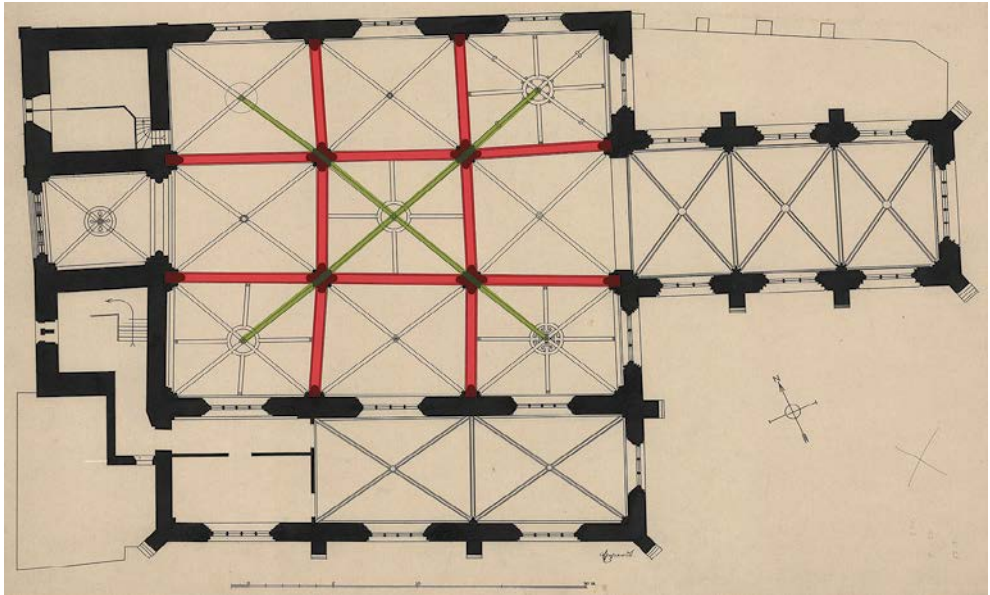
Unser Lieben Frauen, Grundriss mit Markierung der Scheidbögen, die ein griechisches Kreuz ergeben, sowie Diagonalbetonung
